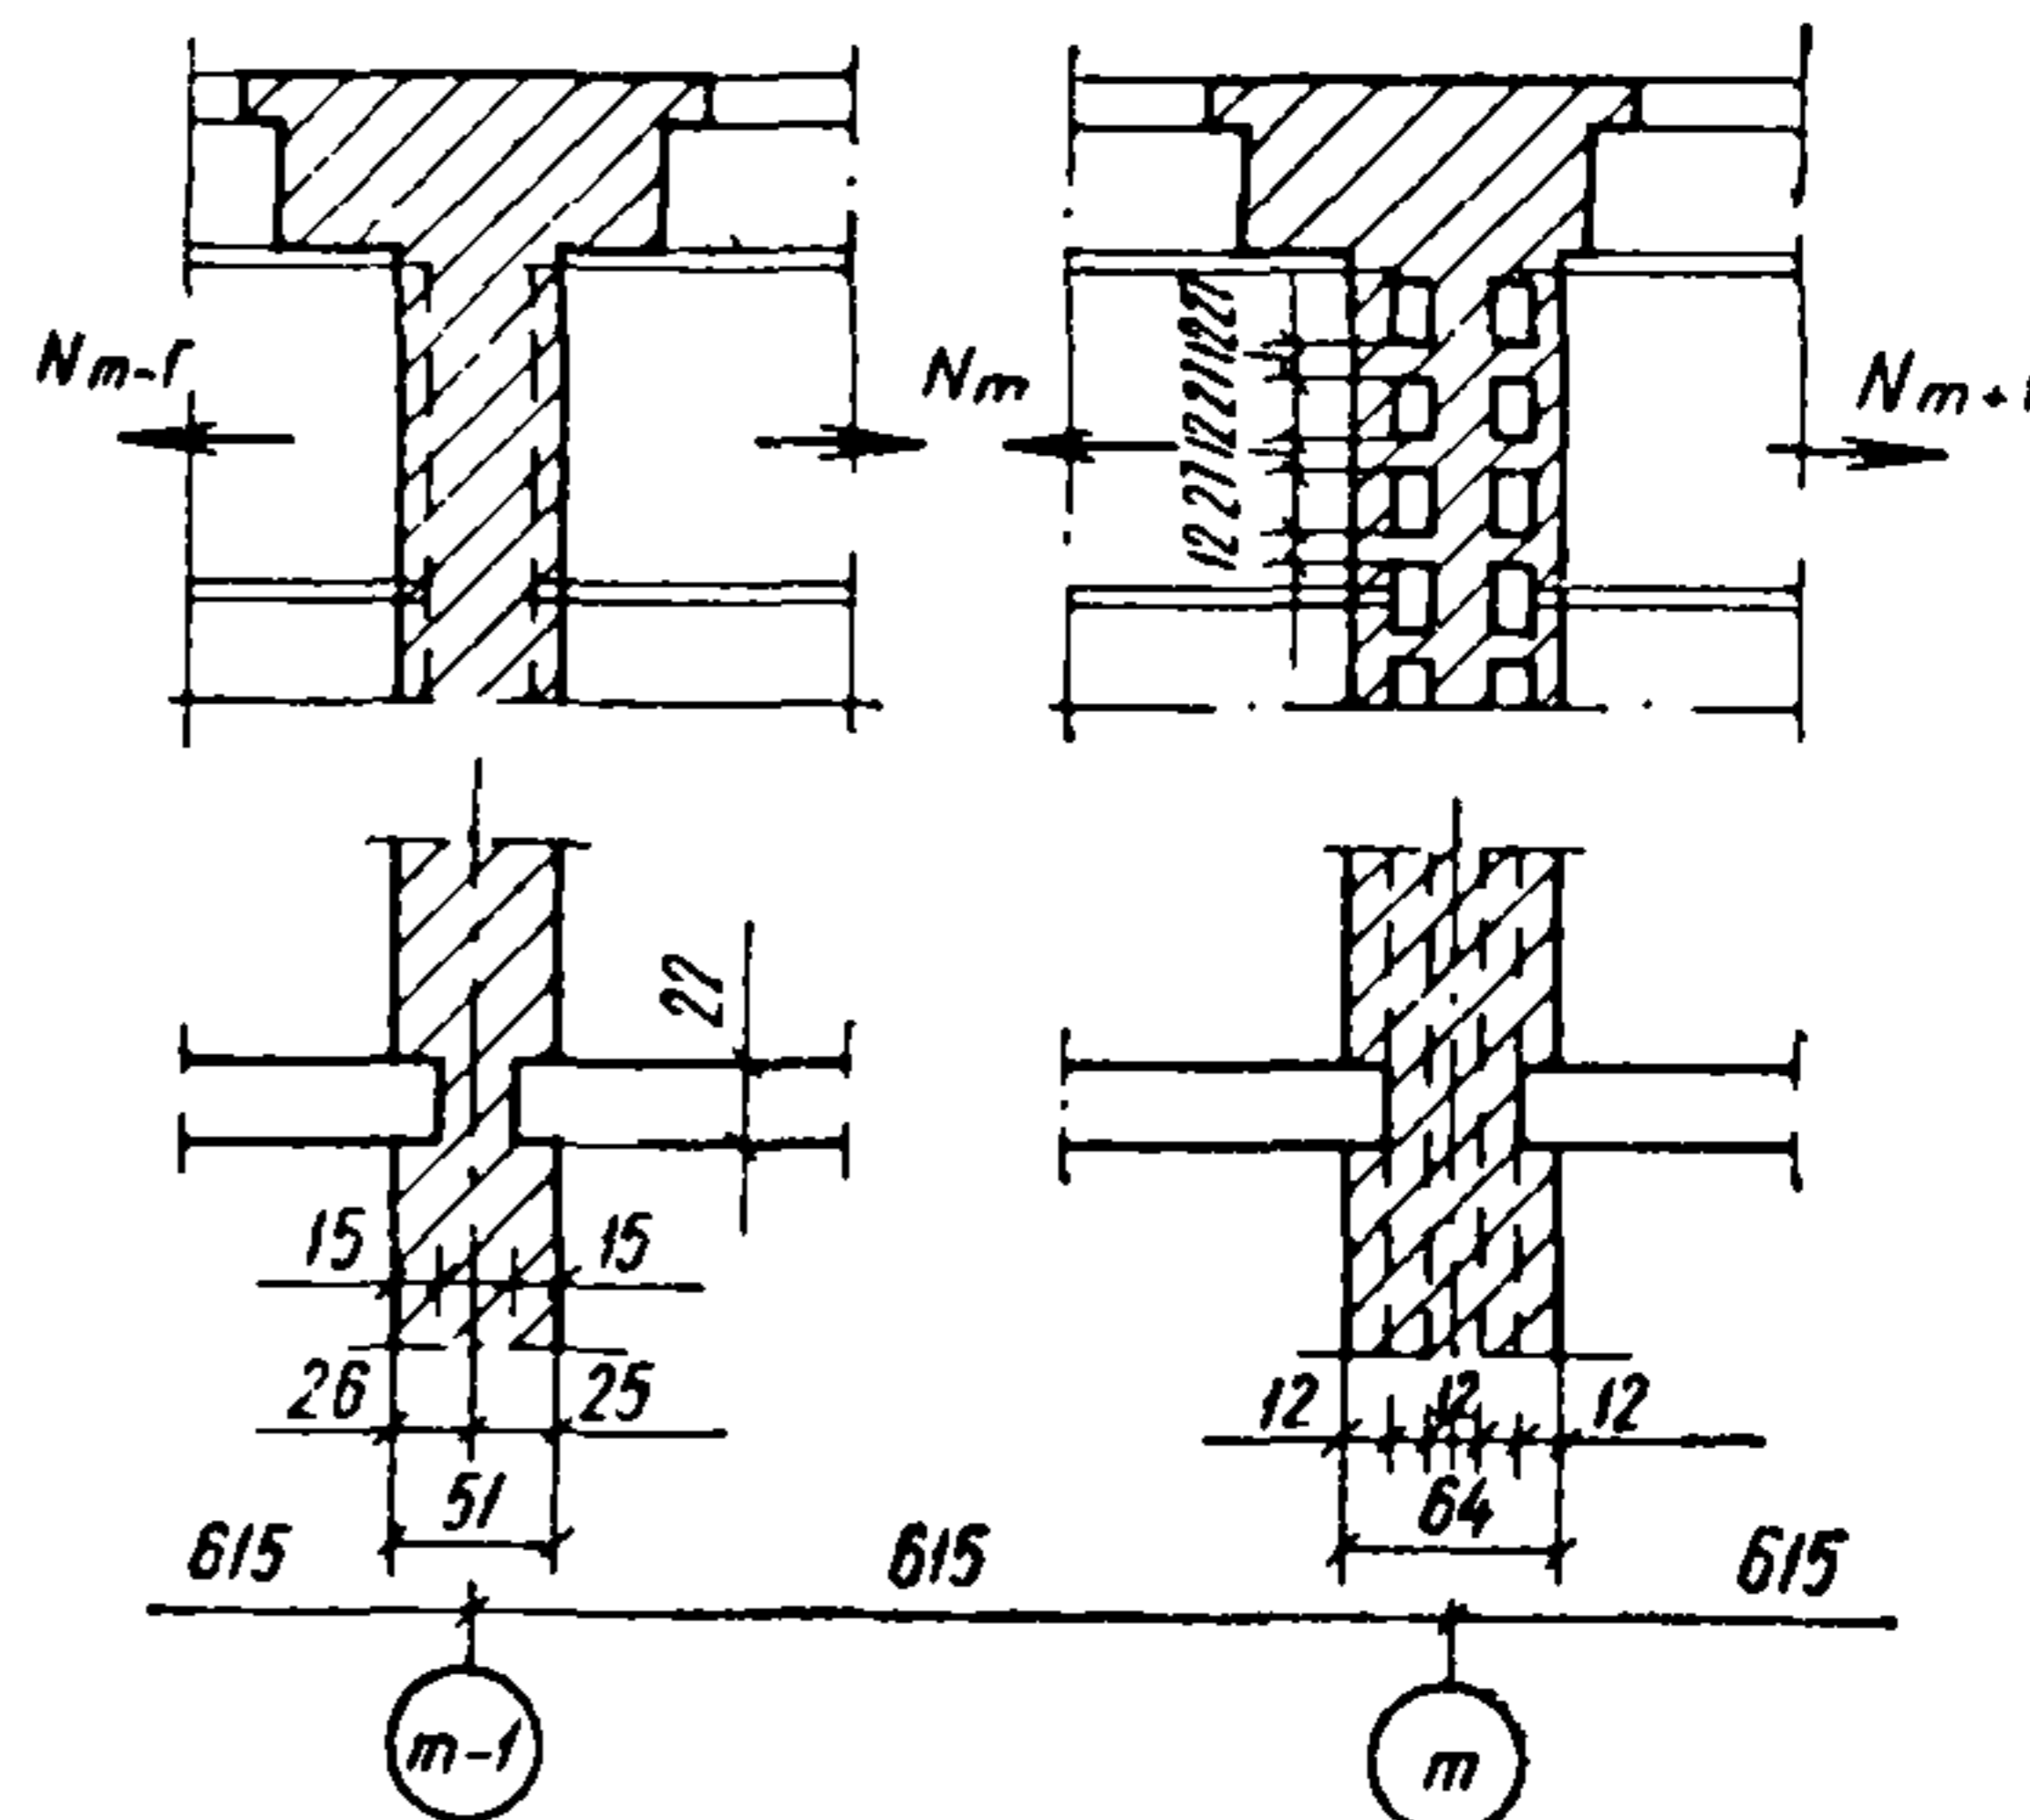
К расчету кладки поперечных стен в местах заделки плит перекрытий
